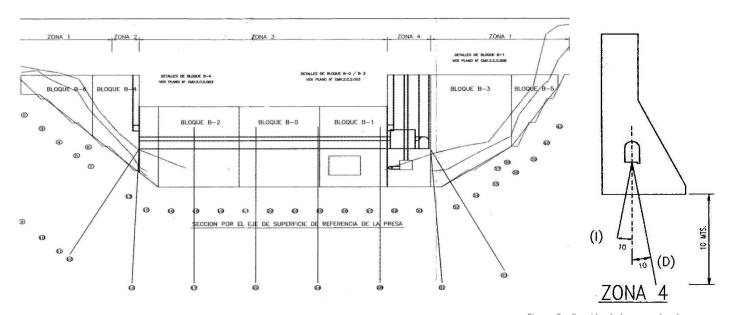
Proyecto de Cortina de Inyecciones de Impermeabilización – Presa Rucacura.
